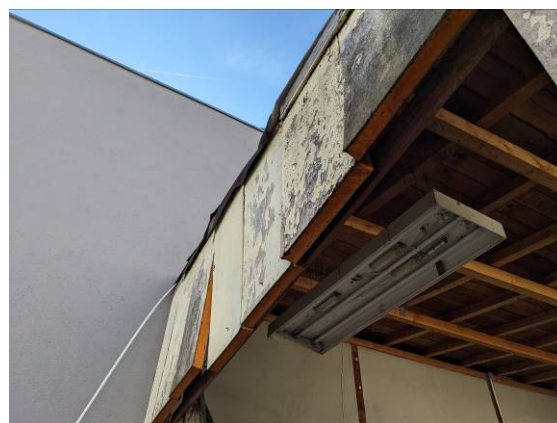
P10 - PU-Schaum orange - Haus 2/Garage - EG
